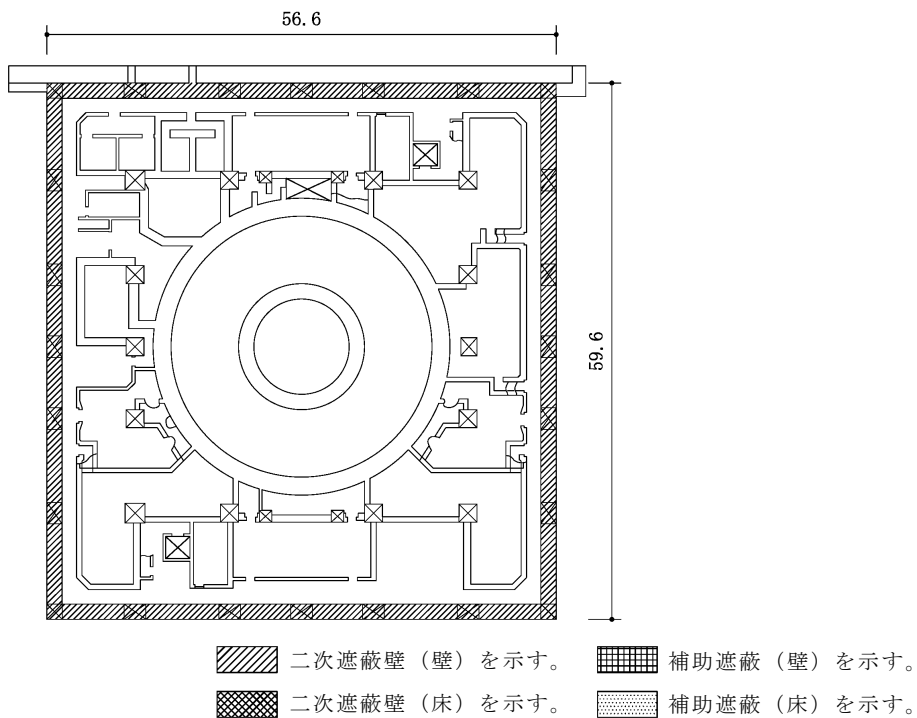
二次遮蔽壁及び補助遮蔽の範囲の平面図
